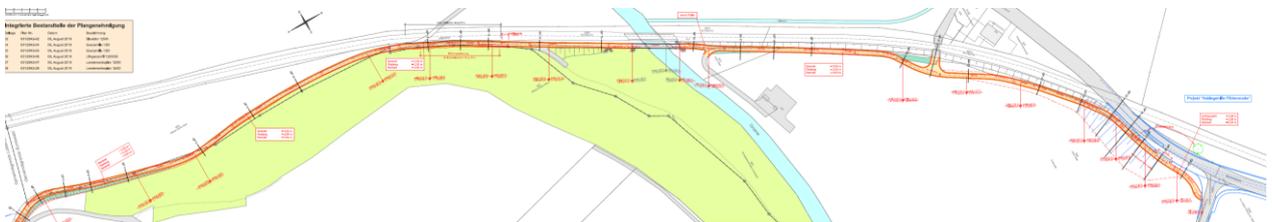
Projektperimeter Strassenplan Abschnitt 2
